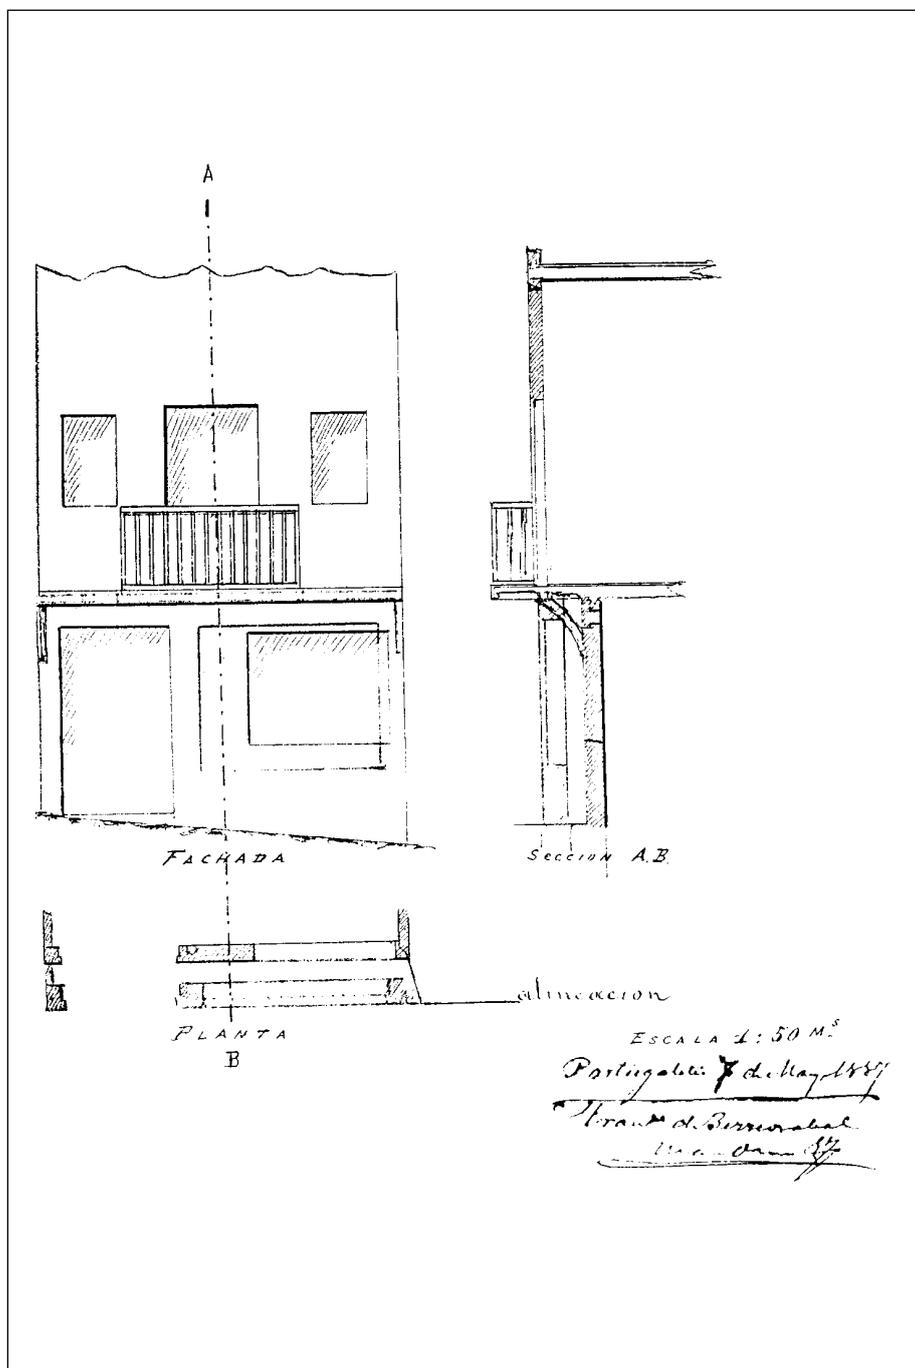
Alzado de la fachada principal de la casa nº 20 de la calle del Medio, en 1887.
